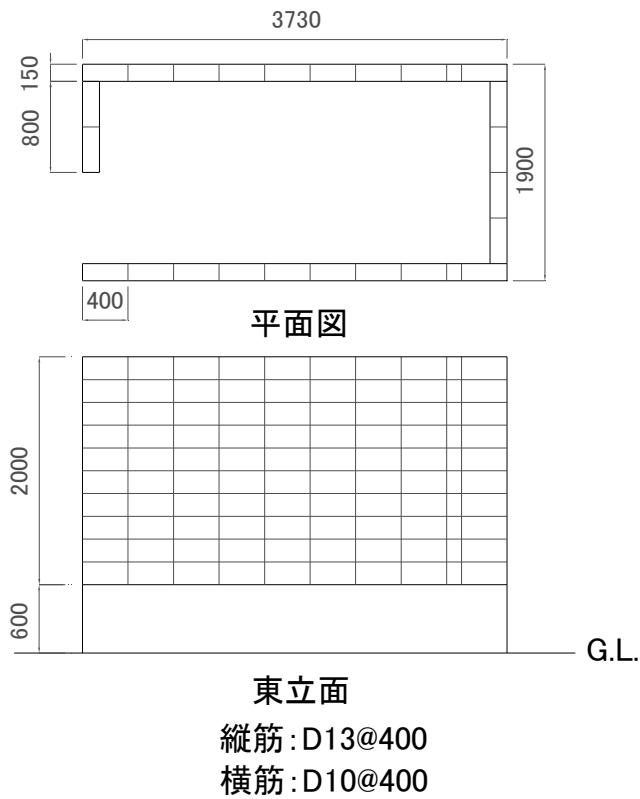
CB 倉庫の平面図・立面図 (単位: mm)
